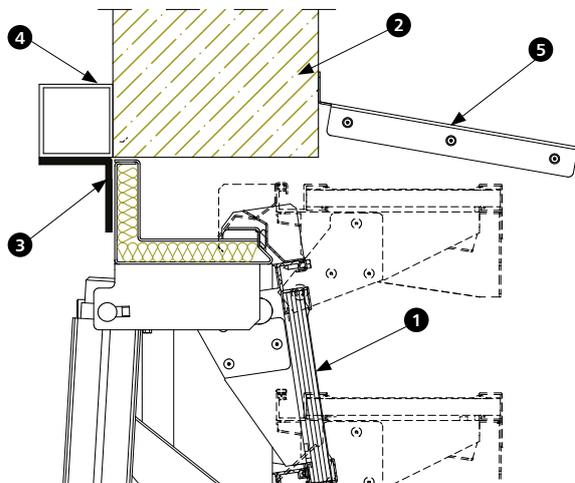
Montage des Lamellenlüfters in der Wand (Fassade) mittels einem Stahlprofil
